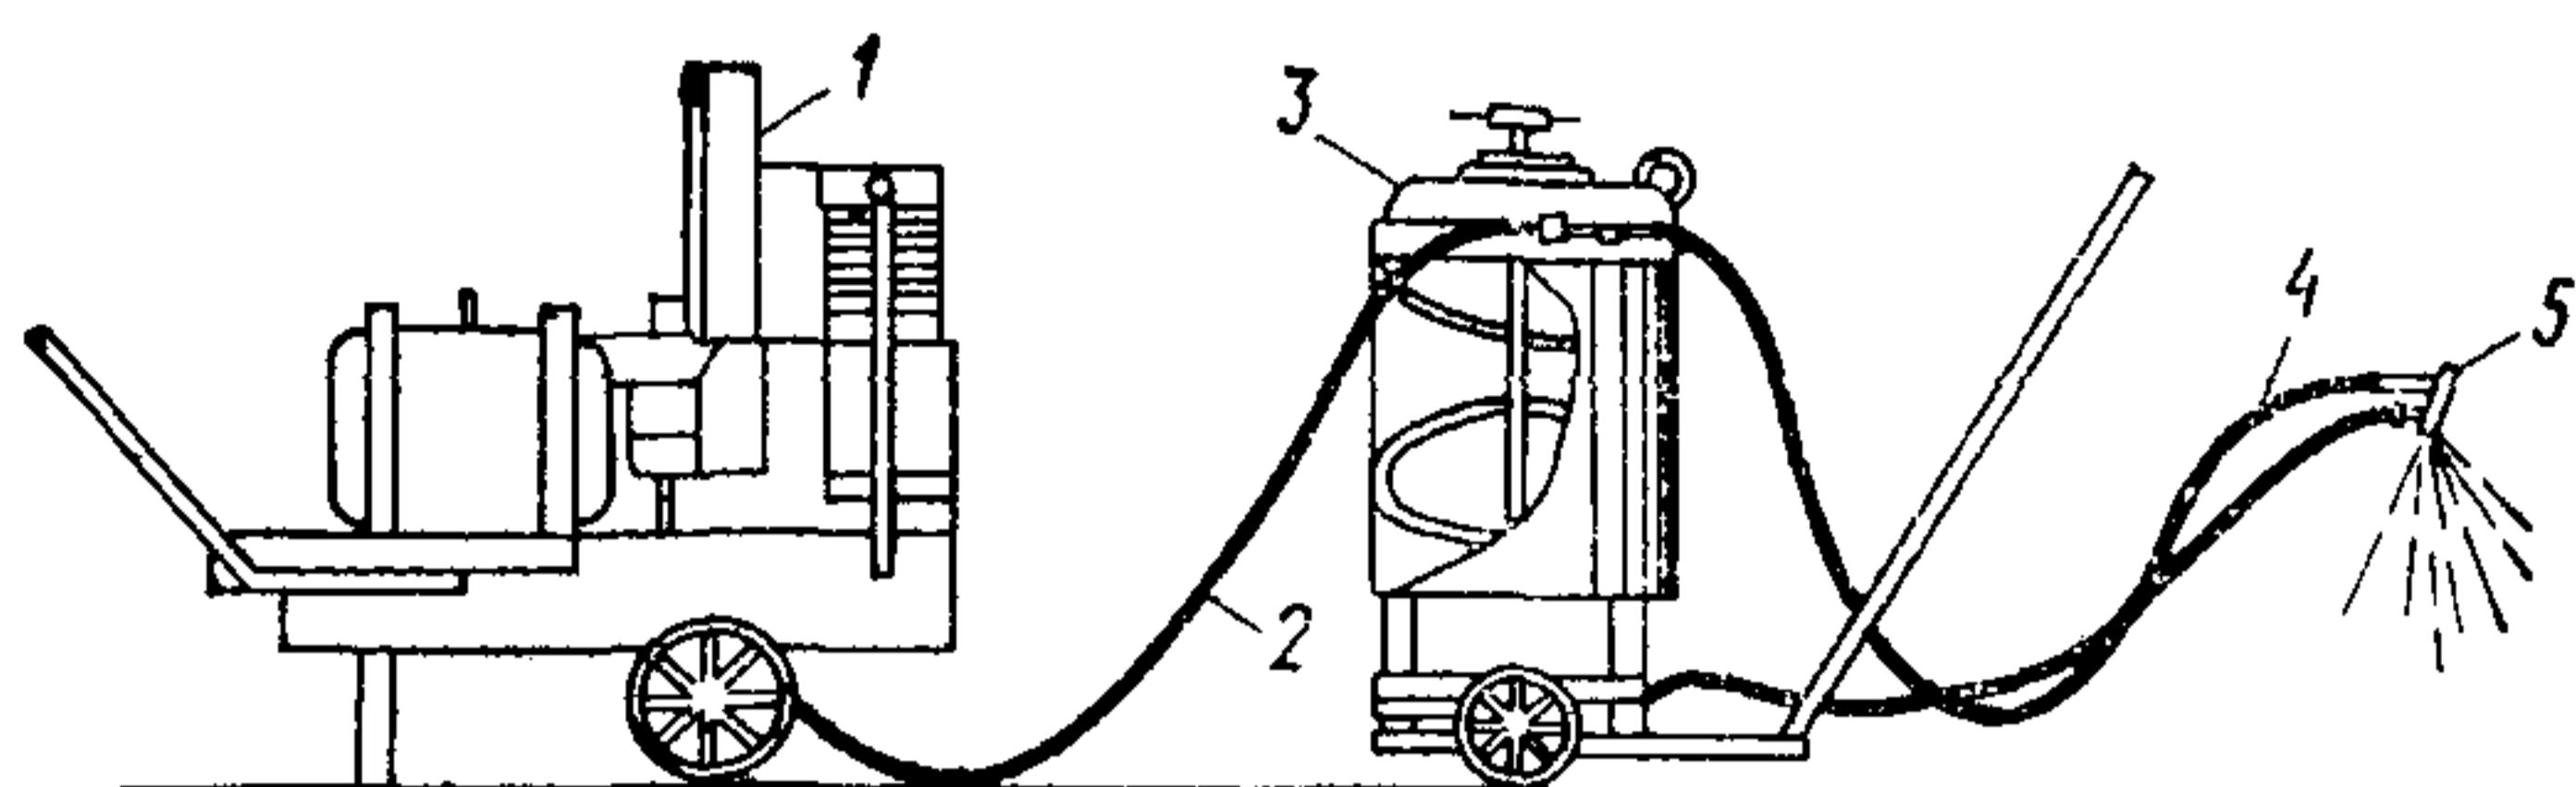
Пневматическая установка для огрунтовки оснований кровель
